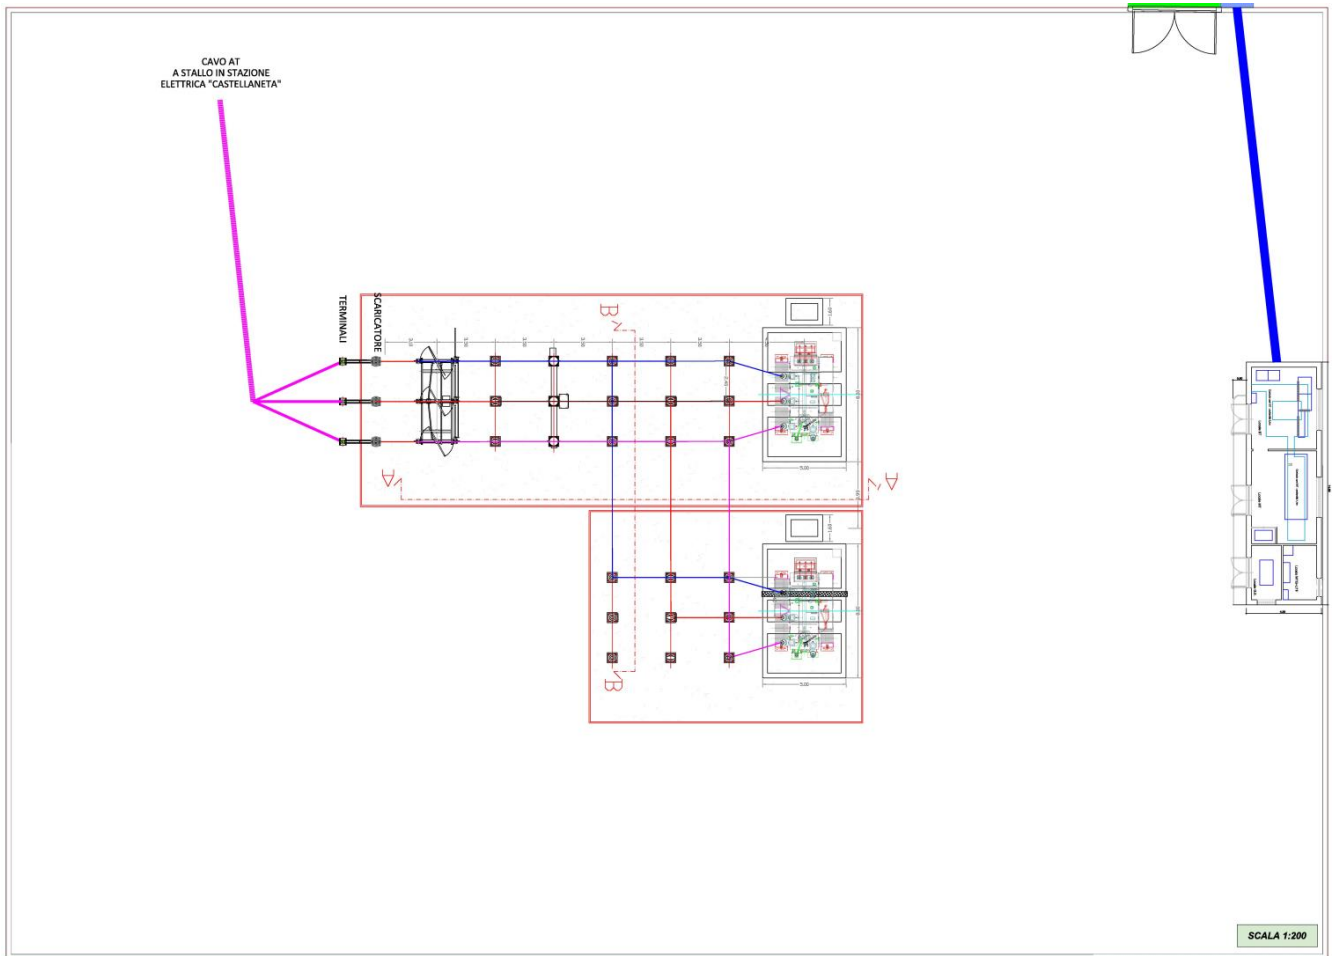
Stazione elettrica utente – schema planimetrico
